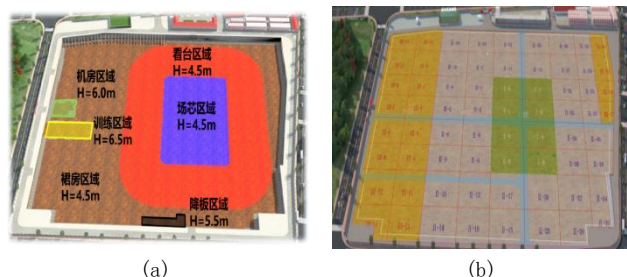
(a) 主赛场基坑示意图;(b) 主赛场桩基平面图
